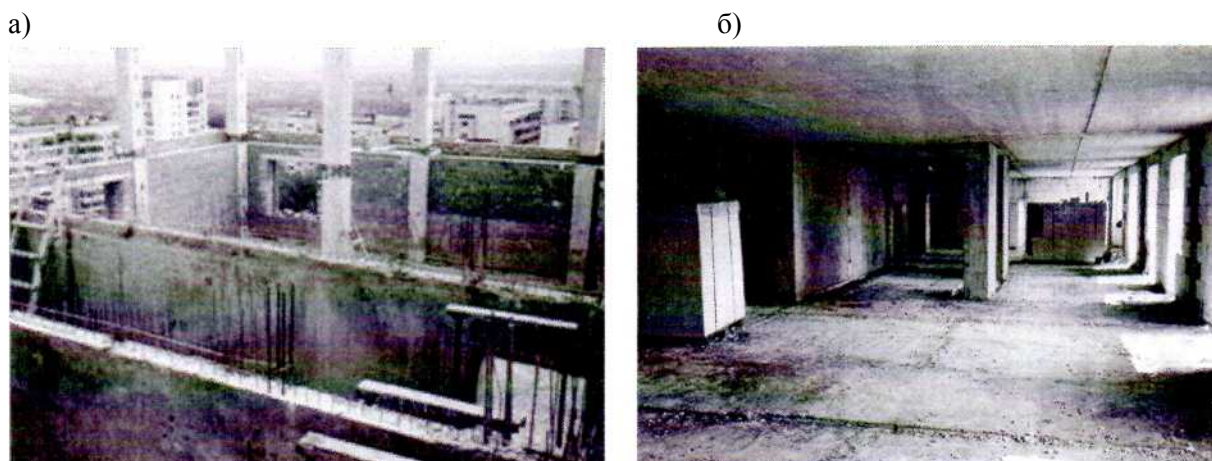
Внутренний объем зданий в процессе строительства: а) с выступающими внутрь колоннами крайнего ряда; б) со смещением колонн крайнего ряда в толщу наружных стен
